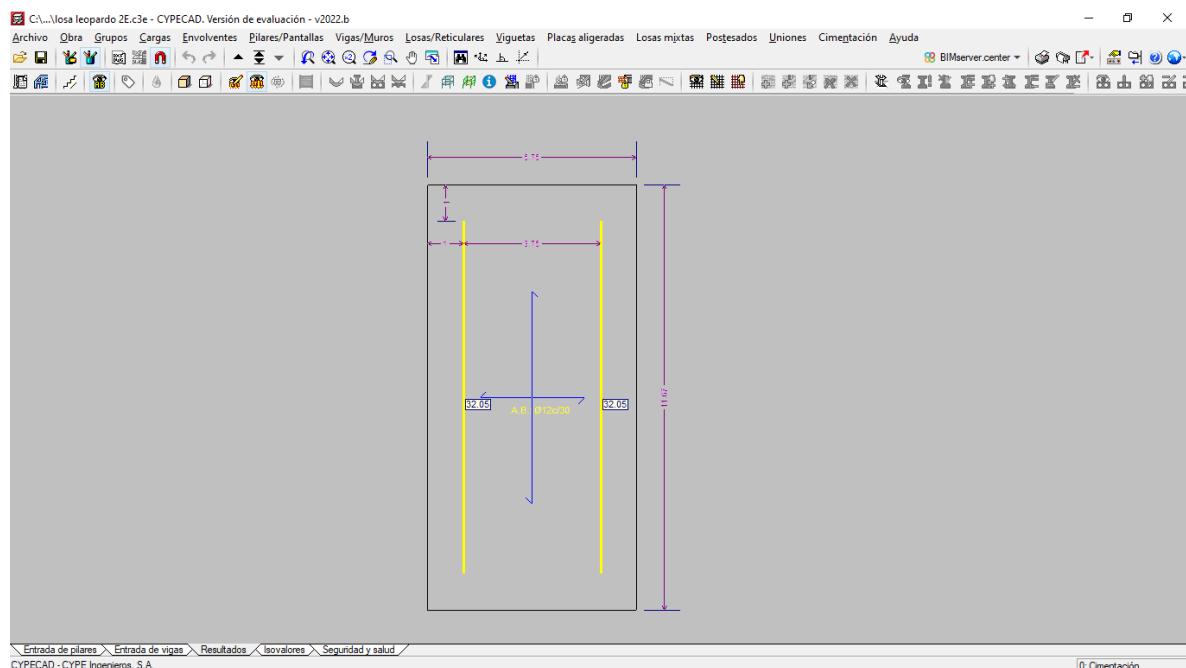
Cálculo armado losa Leopardo 2E (Fuente: elaboración propia)
